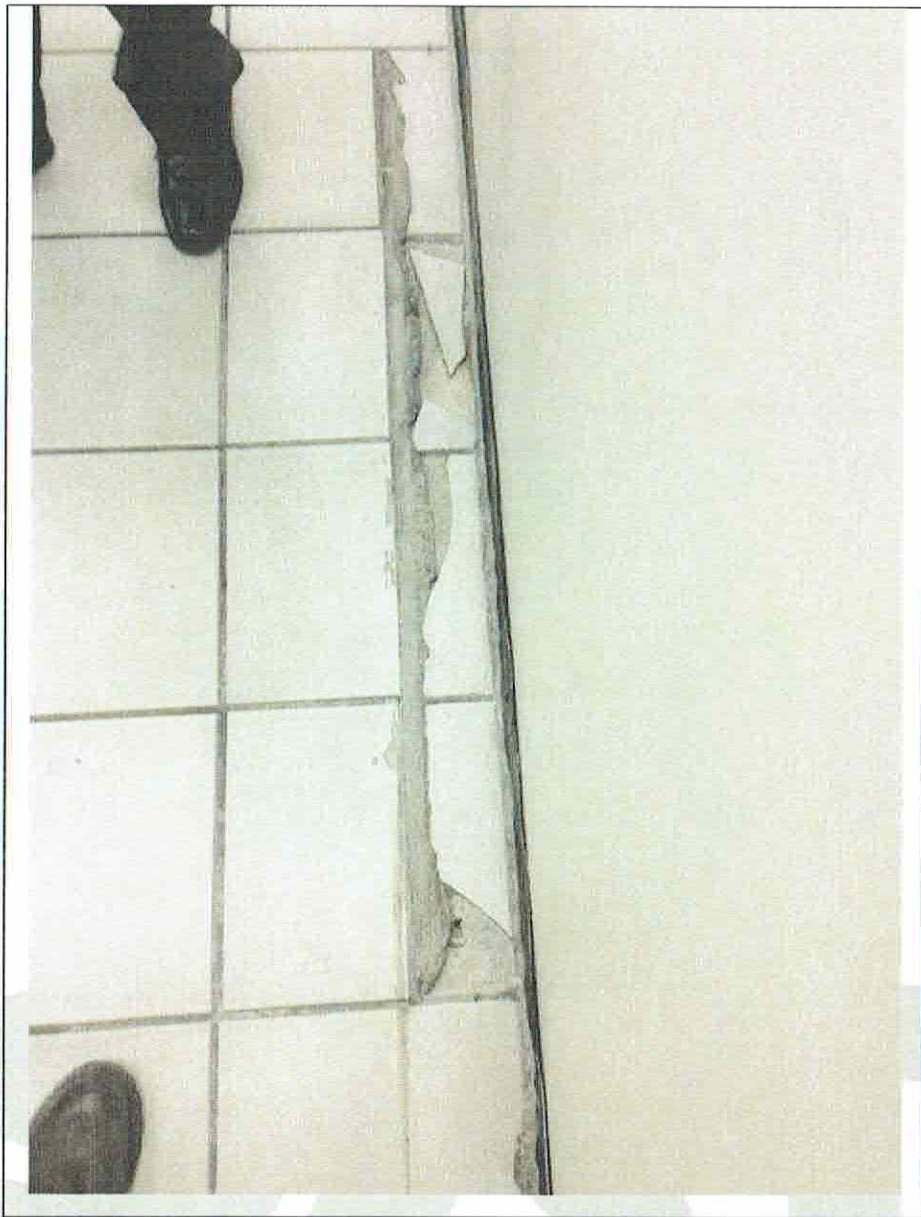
Losetas rotas por desplazamientos de la estructura durante el evento sísmico. Se sugiere su pronta reparación.
